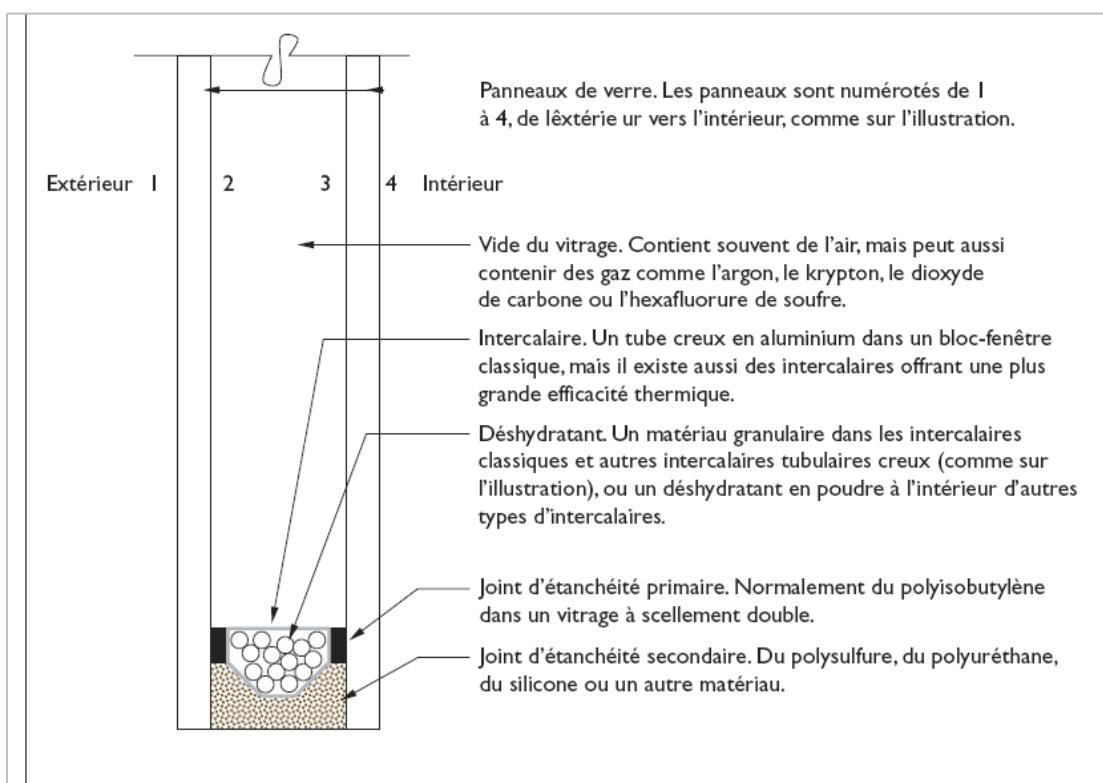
Coupe transversale d'un vitrage isolant caractéristique
